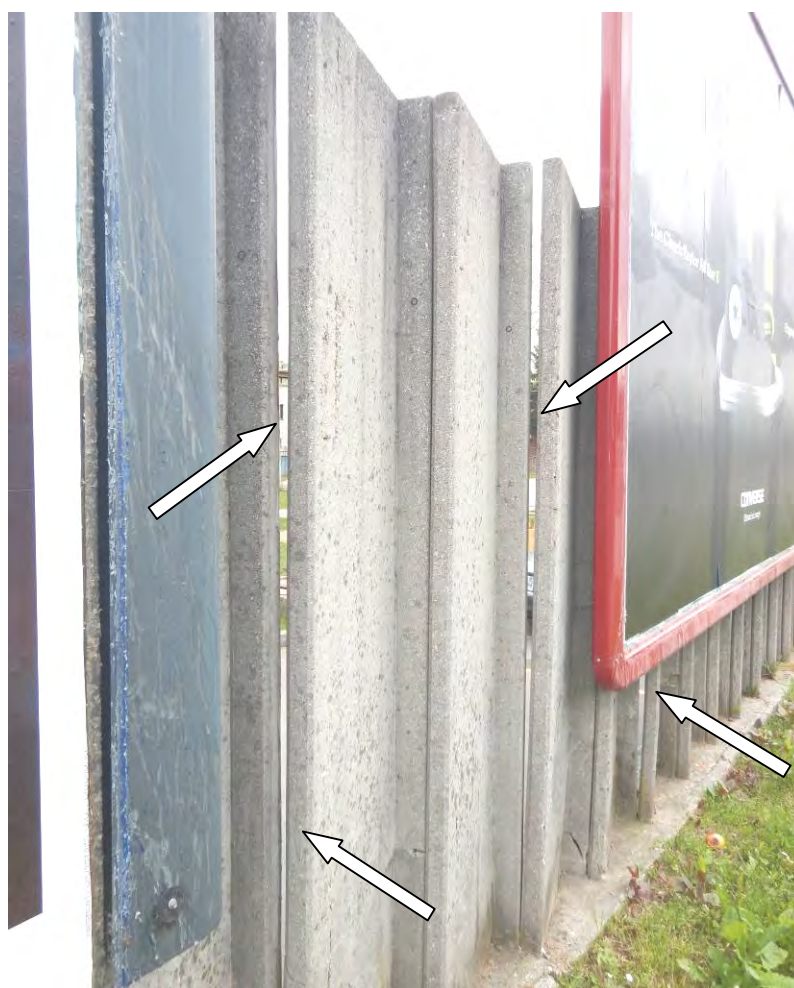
Na določenih lokacijah AB elementov je beton razpokan
